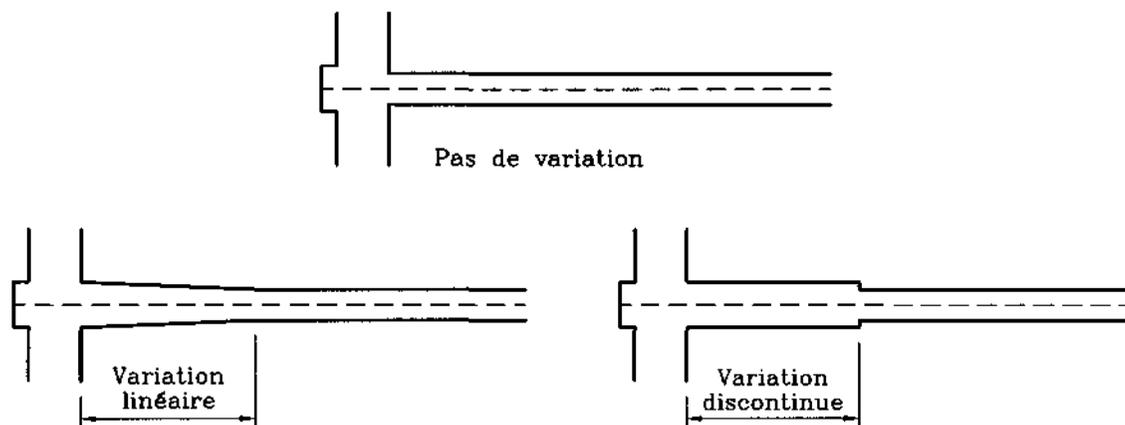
Différentes formes d'épaississement d'âme - Vue en plan
